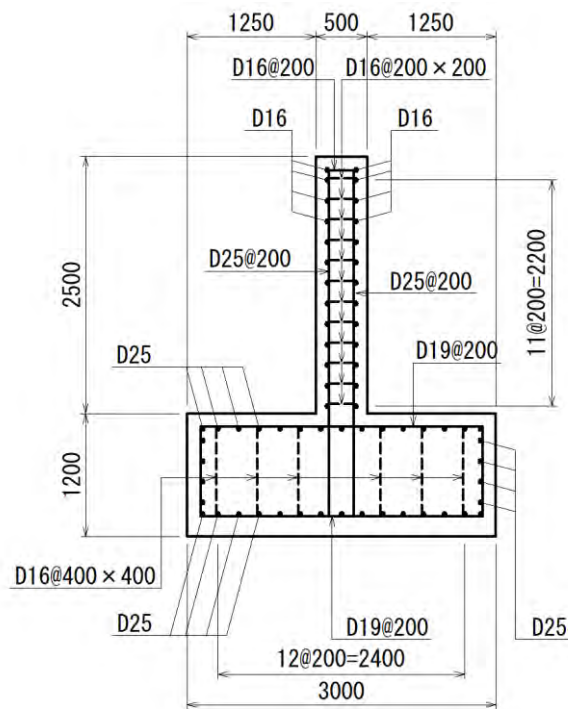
重油タンク (No. 1, 2, 3) の溢水防止壁の概略平面図
